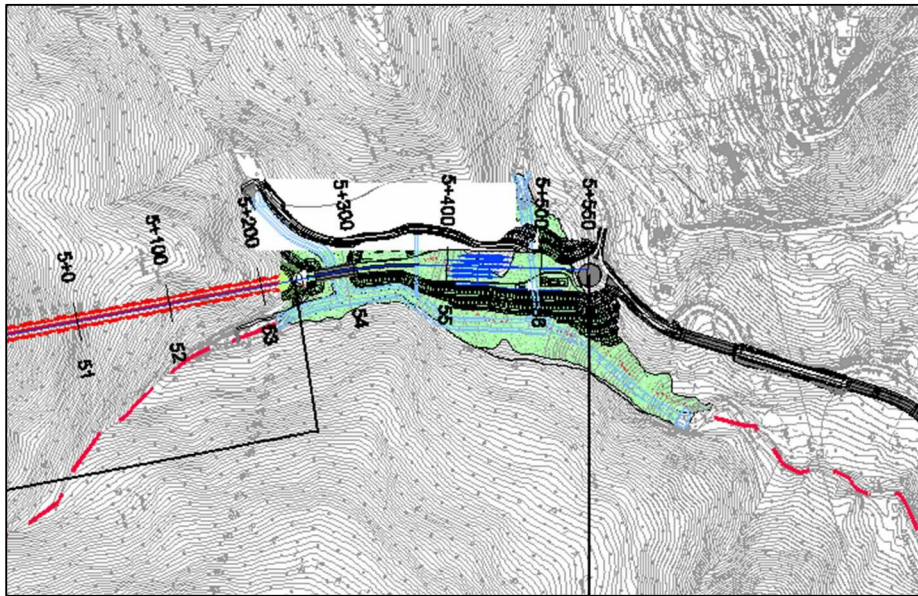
Stralcio planimetrico dell'area lato Fontanabuona, lungo il torrente Litteglia
